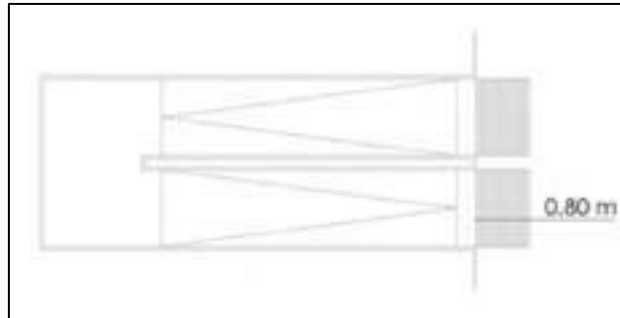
Croquis mesetas de las rampas. Decreto 65/2019.
